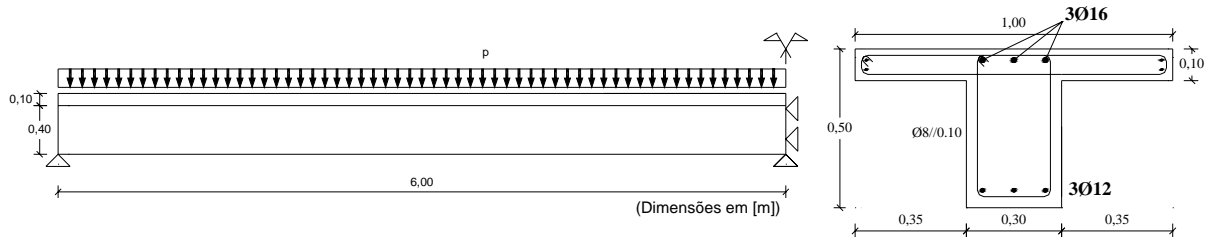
Modelo de dimensionamento da viga de BA contínua com dois vãos de 6.0 m simplesmente apoiada e a pormenorização da secção transversal.
